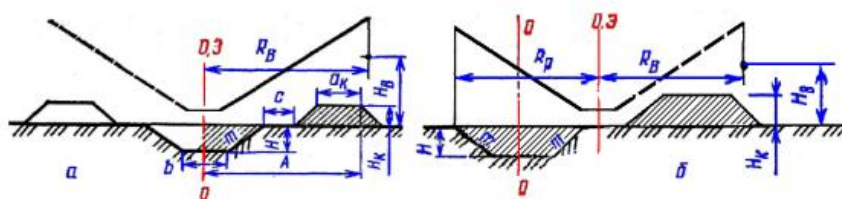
Способы разработки грунта:  $a$  – продольный;  $b$  – поперечный
